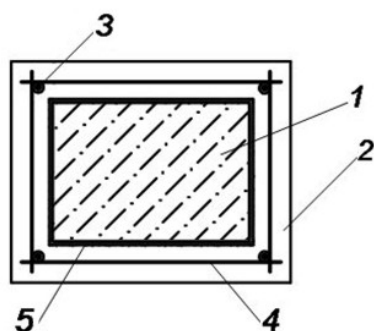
Наружная усиливающая конструкция колонн: 1 – железобетонная колонна, 2 – железобетонная обойма, 3 – продольная арматура, 4 – поперечная арматура, 5 – адгезионная обмазка из жидкого стекла
